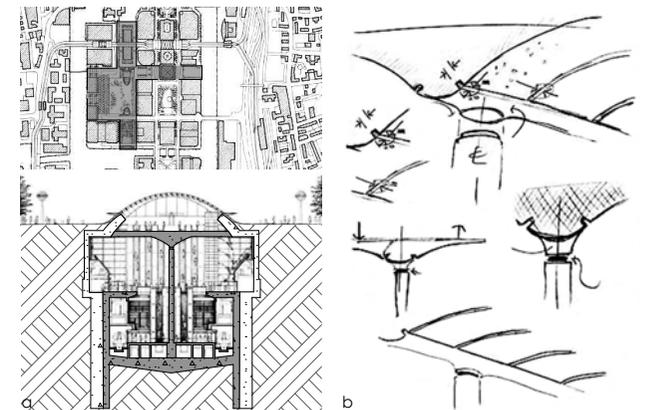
Sección constructiva, bocetos sobre la unión de viga y columna
